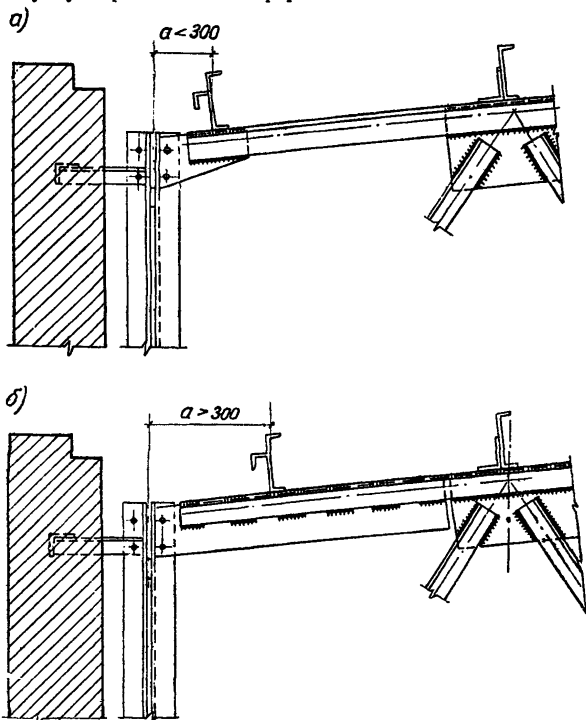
Примеры усиления сечения крайней панели верхнего пояса фермы при наличии местного изгиба
